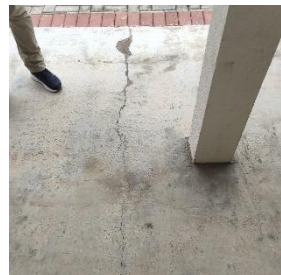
Fissura no piso do residencial de Prudentópolis.
